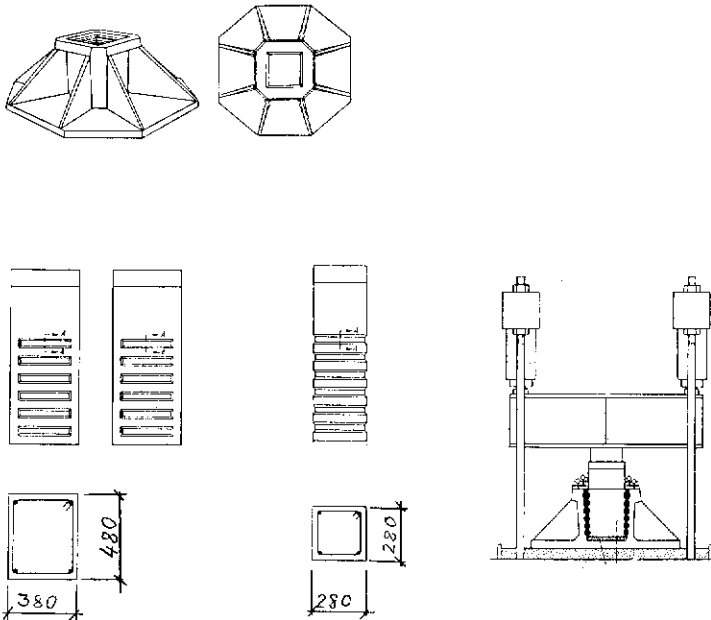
A-Betongs præfabrikerede søjlefundament.
